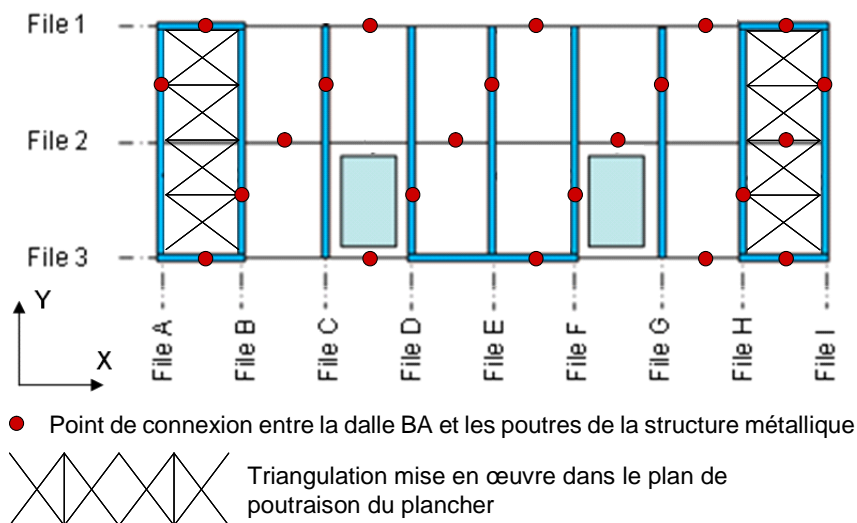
Principe de connexion d'une dalle sur le système de poutraison et renforcement de la triangulation perpendiculairement au sens de la portée des bacs collaborants
